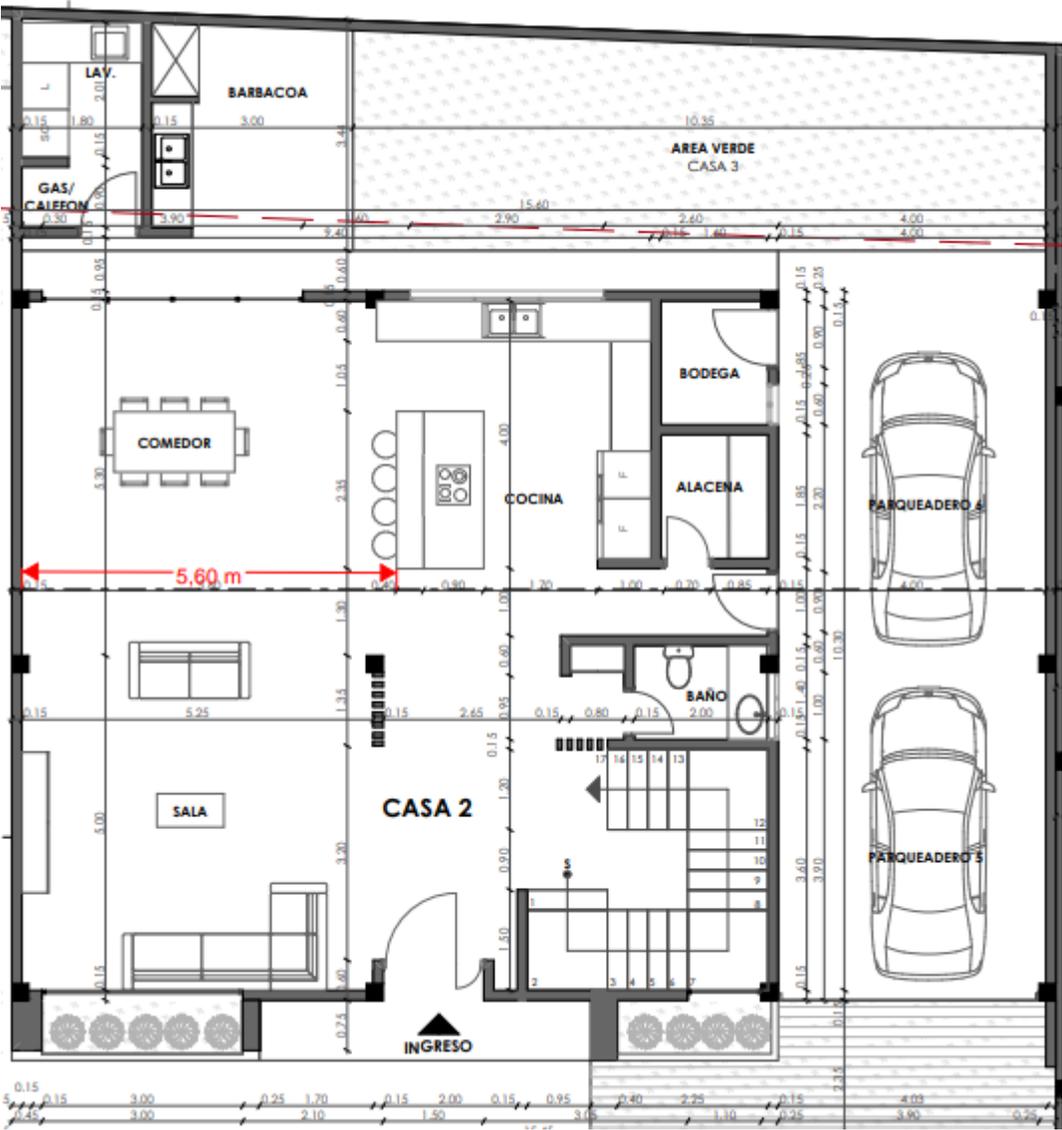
Plano de Planta Baja del Condominio del Bombero
